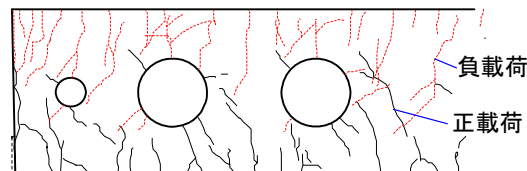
実験時ひび割れ状況 (F-1, R=1/75rad時)
